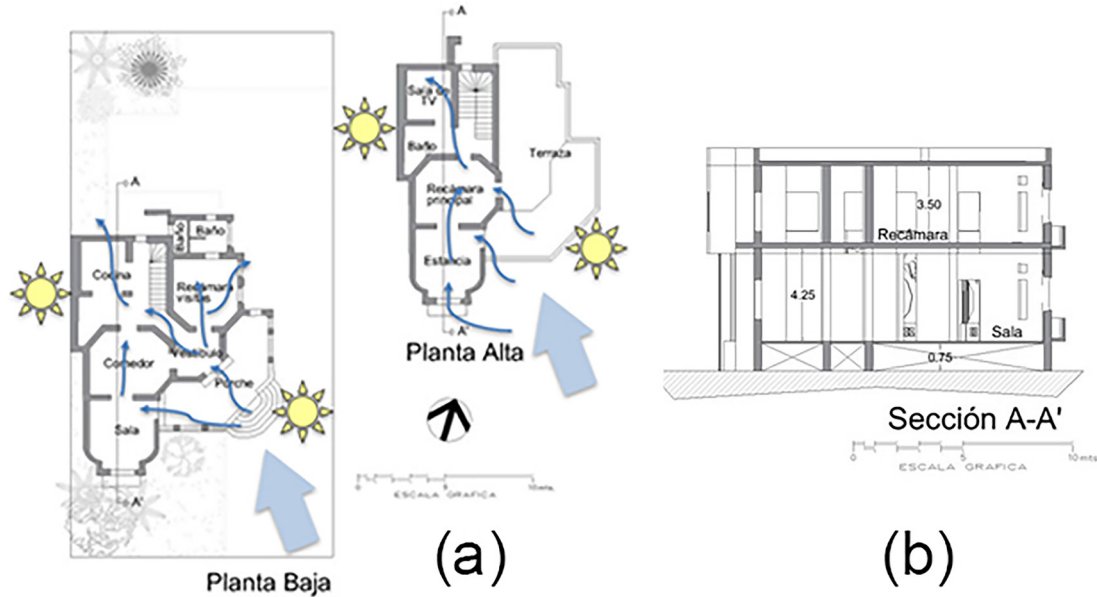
(a) Plantas arquitectónicas (b) Corte. Fuente. Elaboración de los autores
